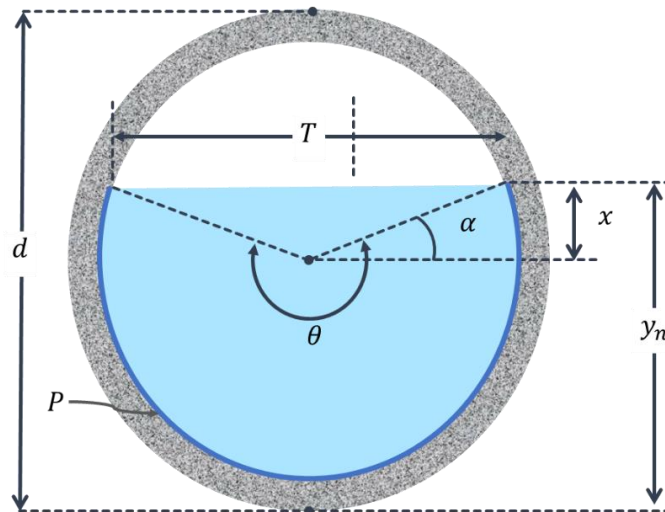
Sección transversal tubería fluyendo parcialmente llena. Tomado y modificado de (Saldarriaga, 2021)
